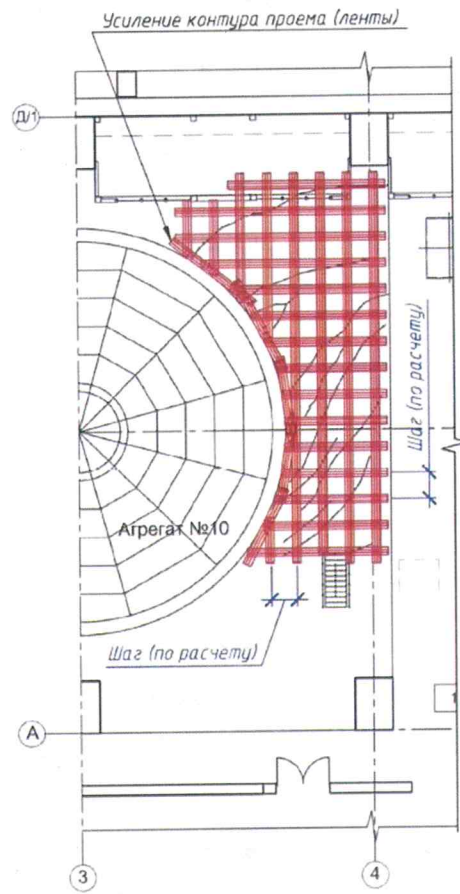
Усиление перекрытия машинного зала здания ГЭС
